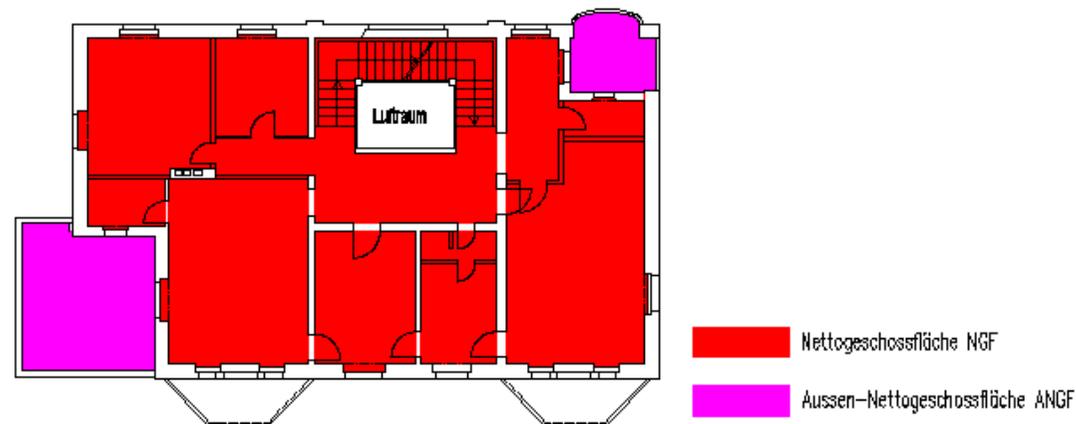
Darstellung Nettogeschossflächen und Aussen-Nettogeschossflächen
